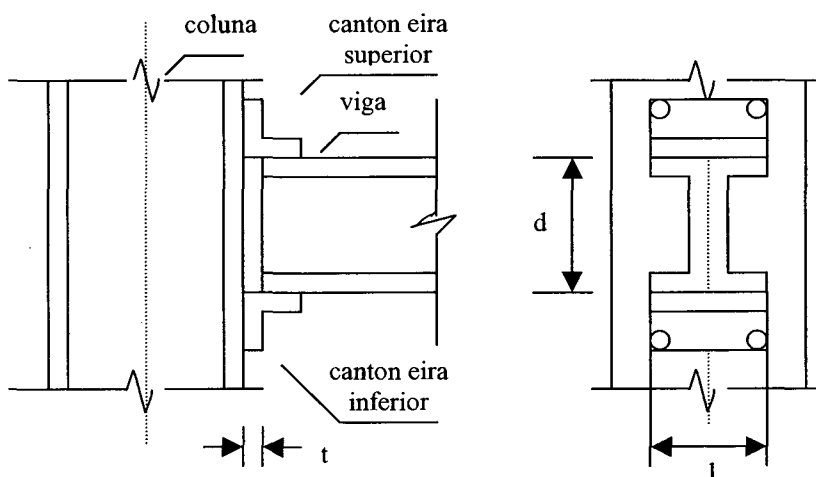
Típica conexão viga-pilar metálica “top and seat angle”.
